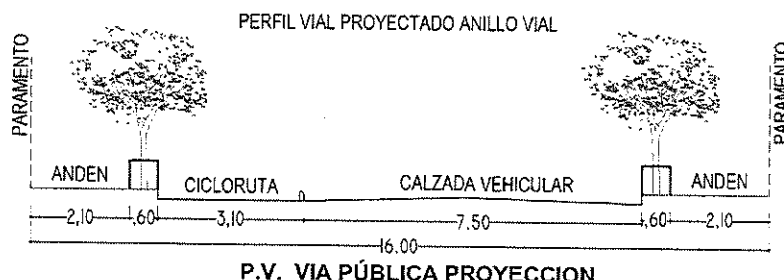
Perfil vial propuesto LOTE VIA DE ACCESO Y VIA PUBLICA
